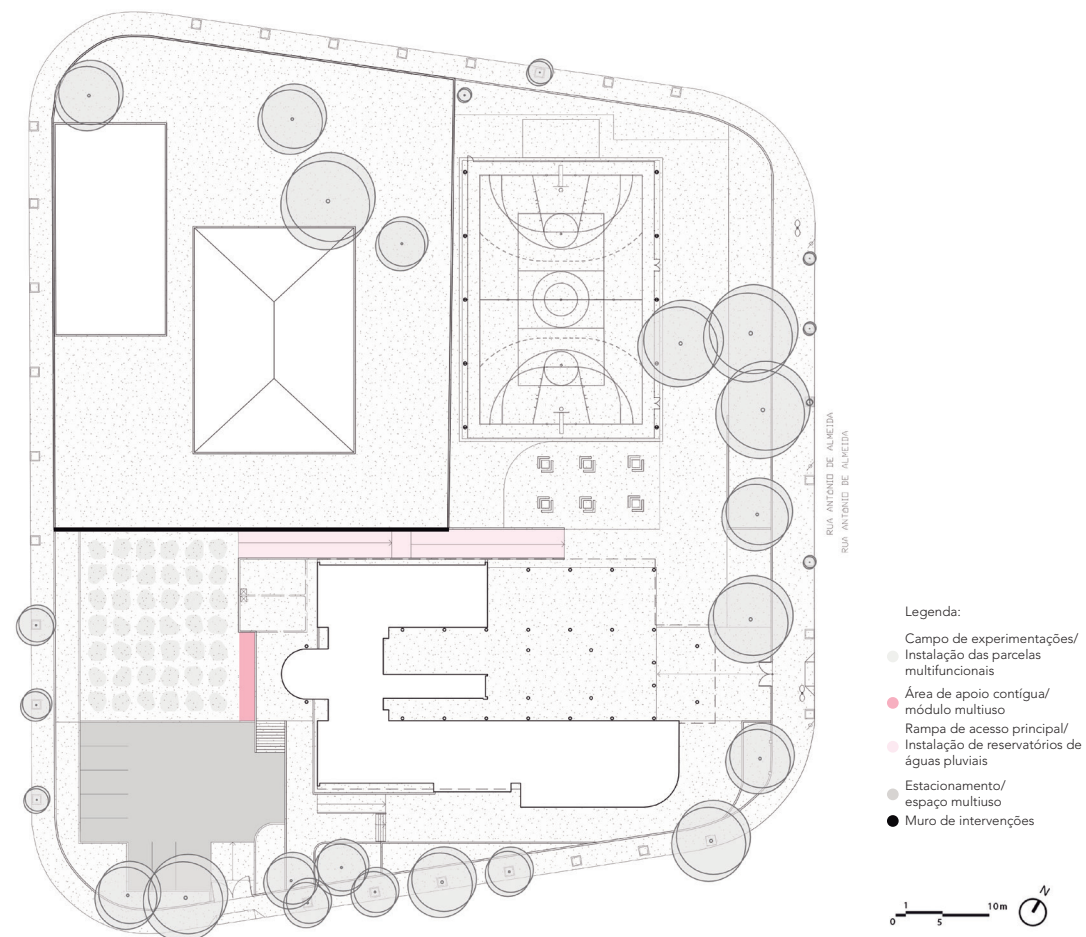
Planta baixa setorizada da proposta geral de intervenção na horta da E. M. Rodrigo Otávio.
